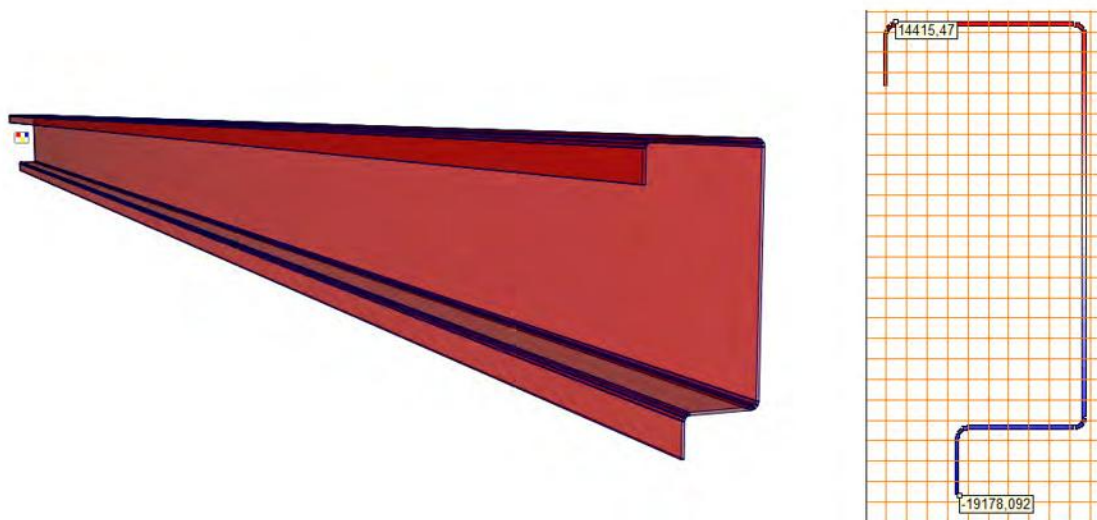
Общий вид и поперечное сечение балки перекрытия 200-2,5 производства АО «СКДМ»
